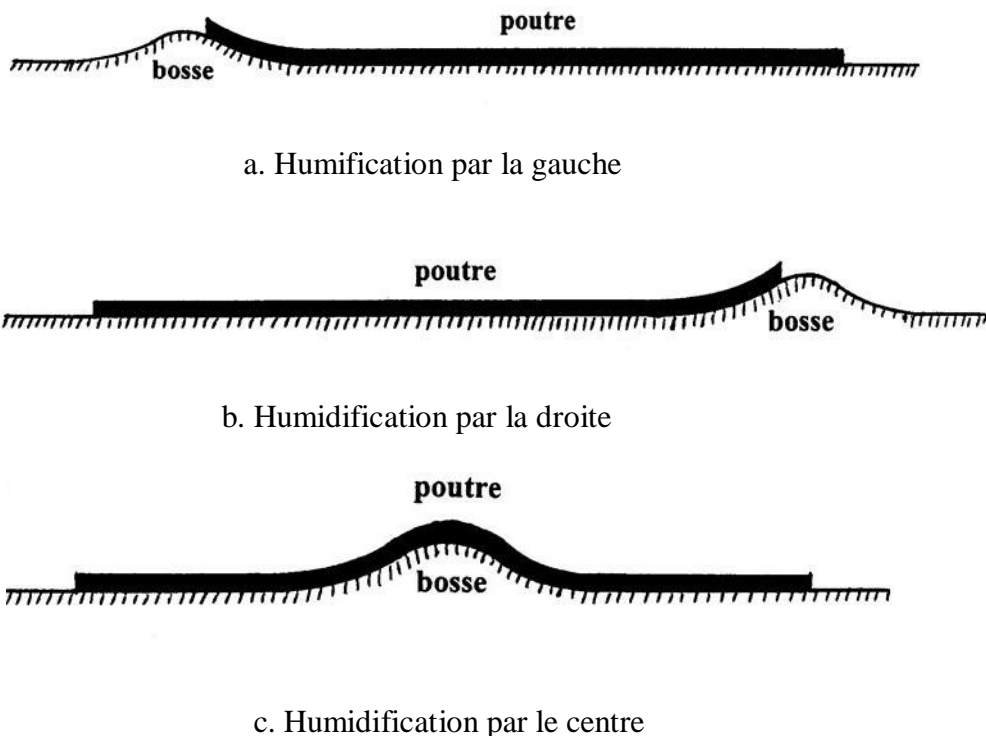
Comportement d'une poutre de fondation sur sol gonflant
